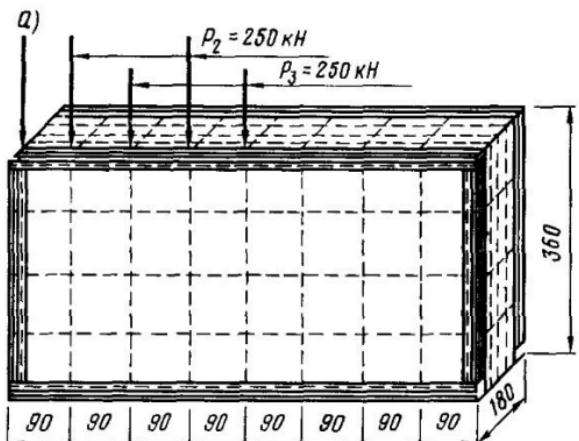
Схема предельных нагрузок на понтон при использовании его в конструкциях подмостей:
